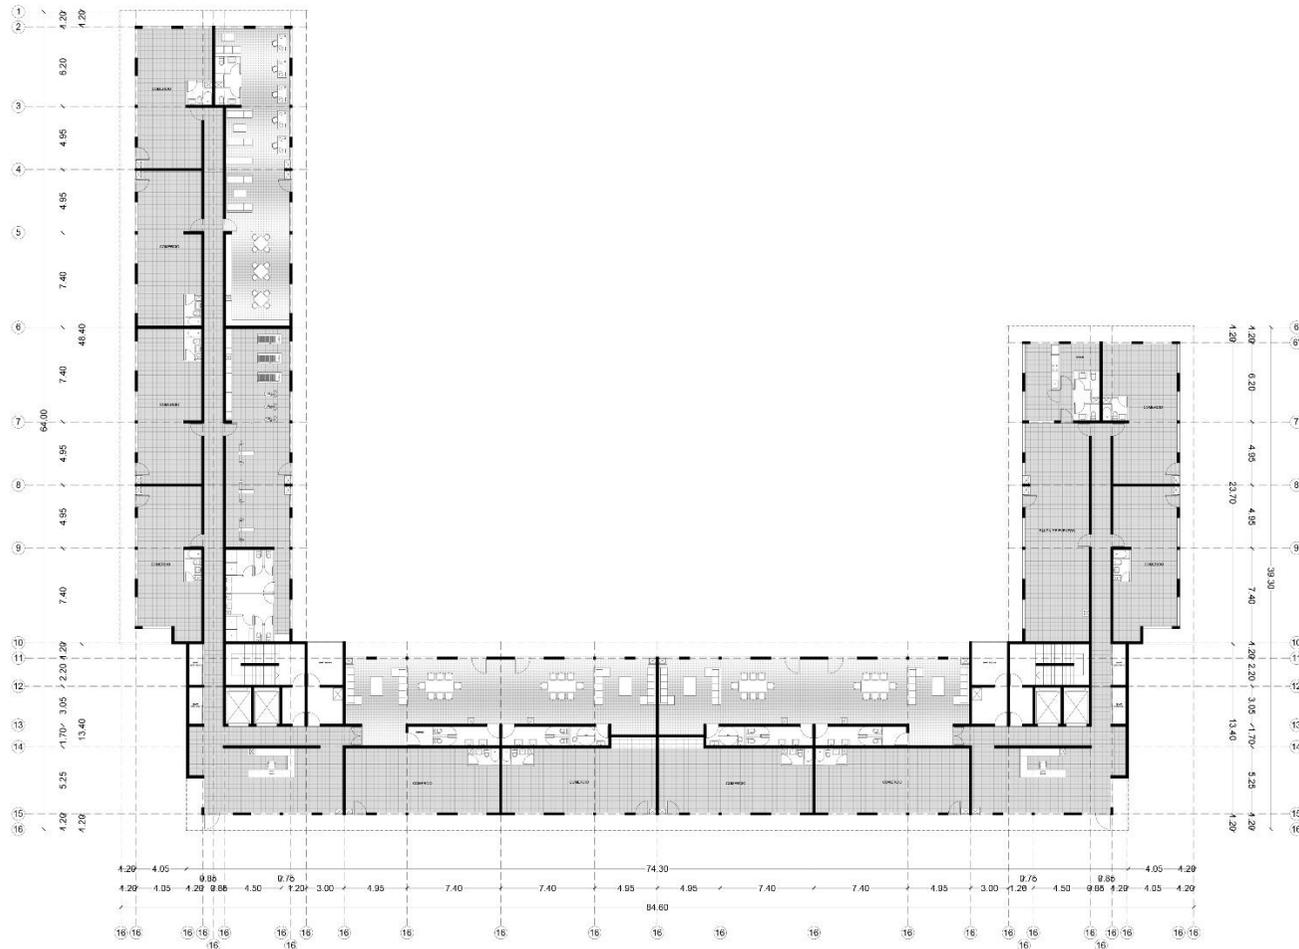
Planta 1° edificio 6/8 pisos, escala 1/300. Fuente: Elaboración propia.
